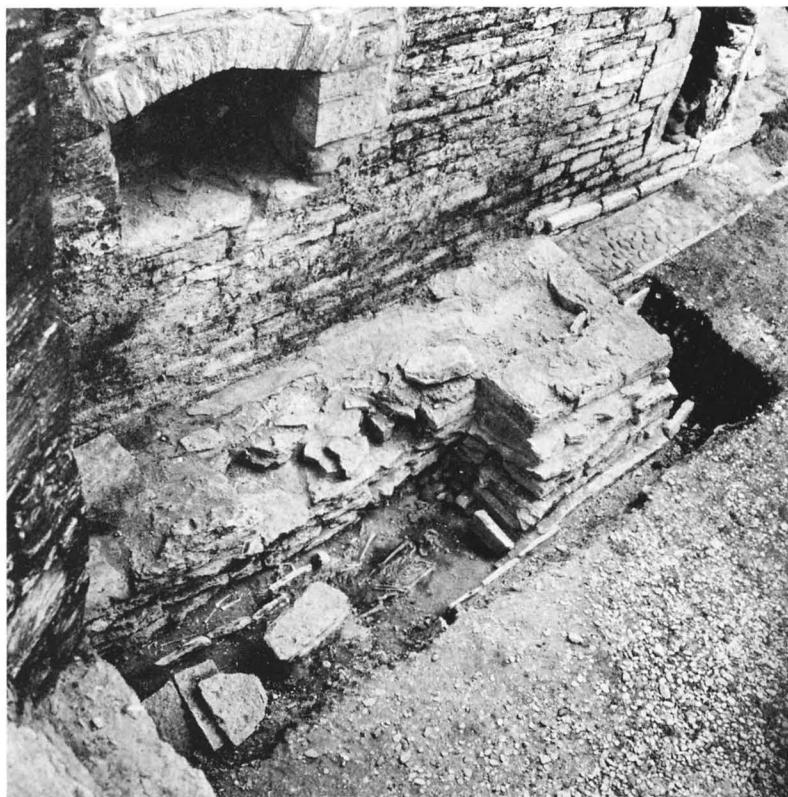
Grunden till det aldrig utförda koret från nordost med grundklacken för dess pilaster. Upp till det nuvarande korets södra mur. Foto W Falck 1972.
